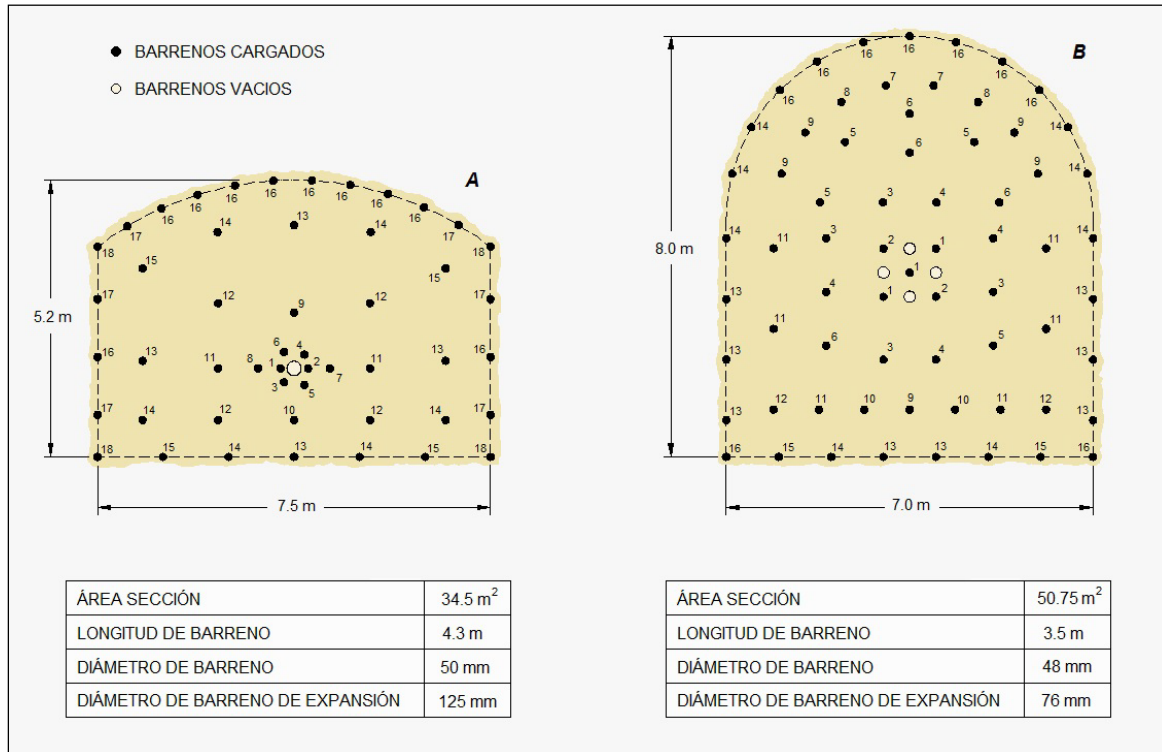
Plantillas de cuña quemada para túneles, con perforación en la bóveda para poscorte. A. Obtenida de [49] Hoek (1985); B. Plantilla utilizada en las excavaciones subterráneas de las Obras de Generación en la C. H. La Yesca.
